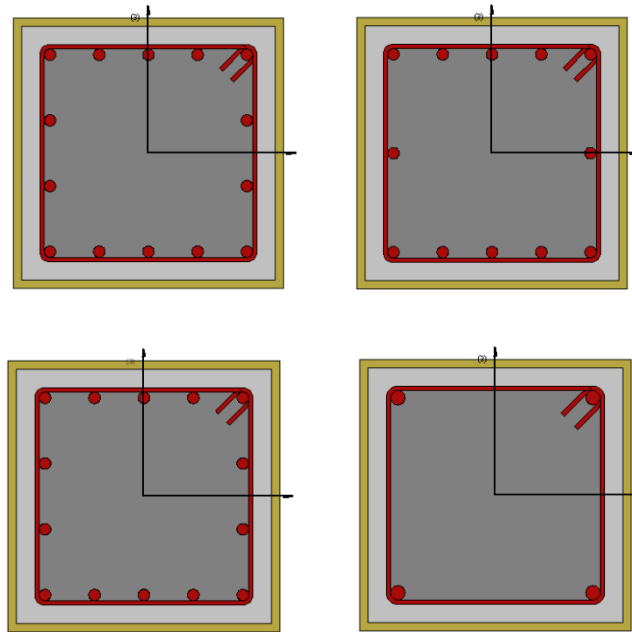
Secções transversais dos pilares com encamisamento em CFRP.
